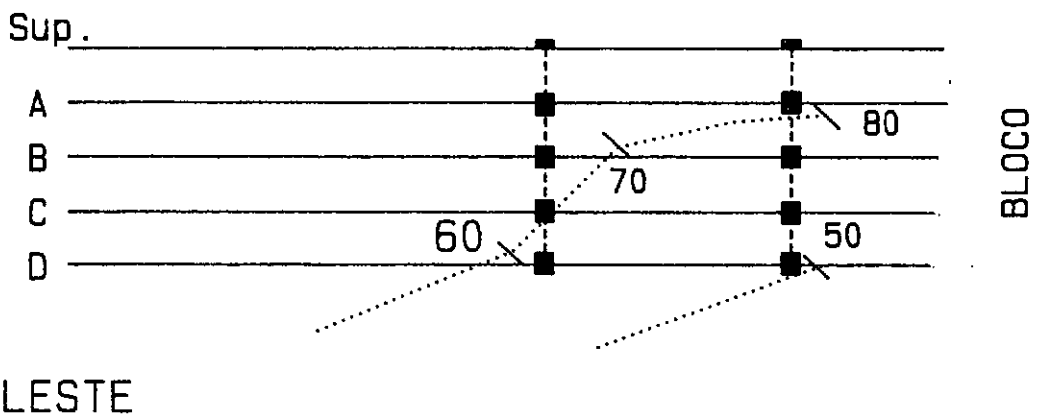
b Fissuras na seção 3 da viga VB1,
